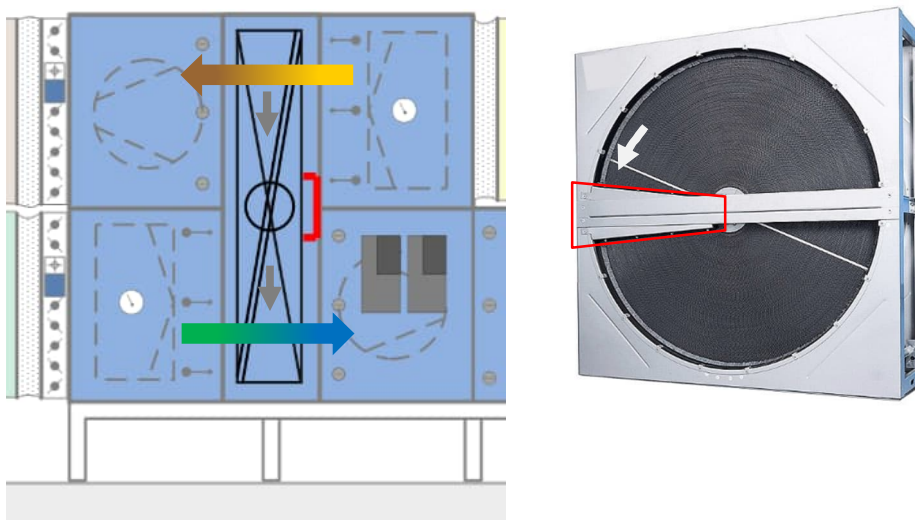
Rotations-WRG mit Spülkammer (rot markiert) und mögliche Ausführung (Quelle: Klingenburg)
